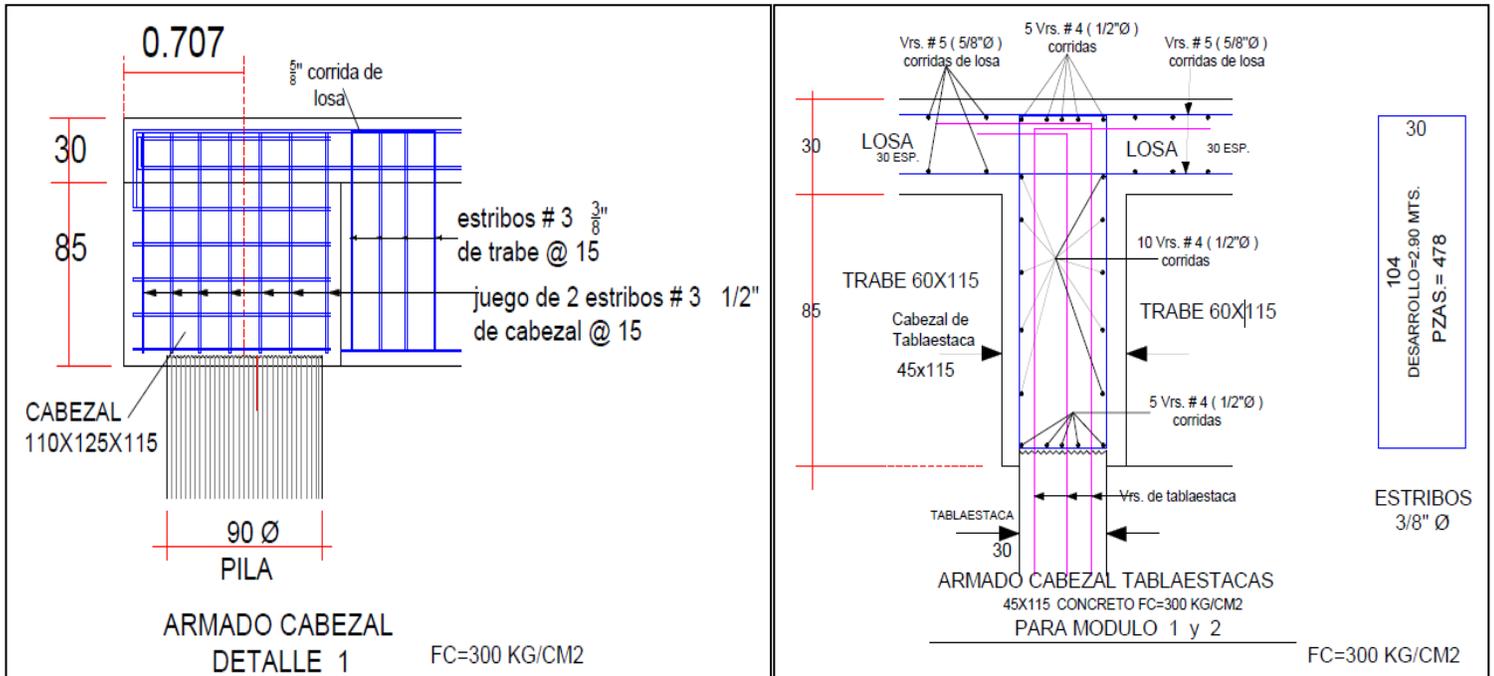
Corte de Trabes y desarrollos de estribos con cabezales armados y Tablaestacas (Plano Ejecutivo # 6).
